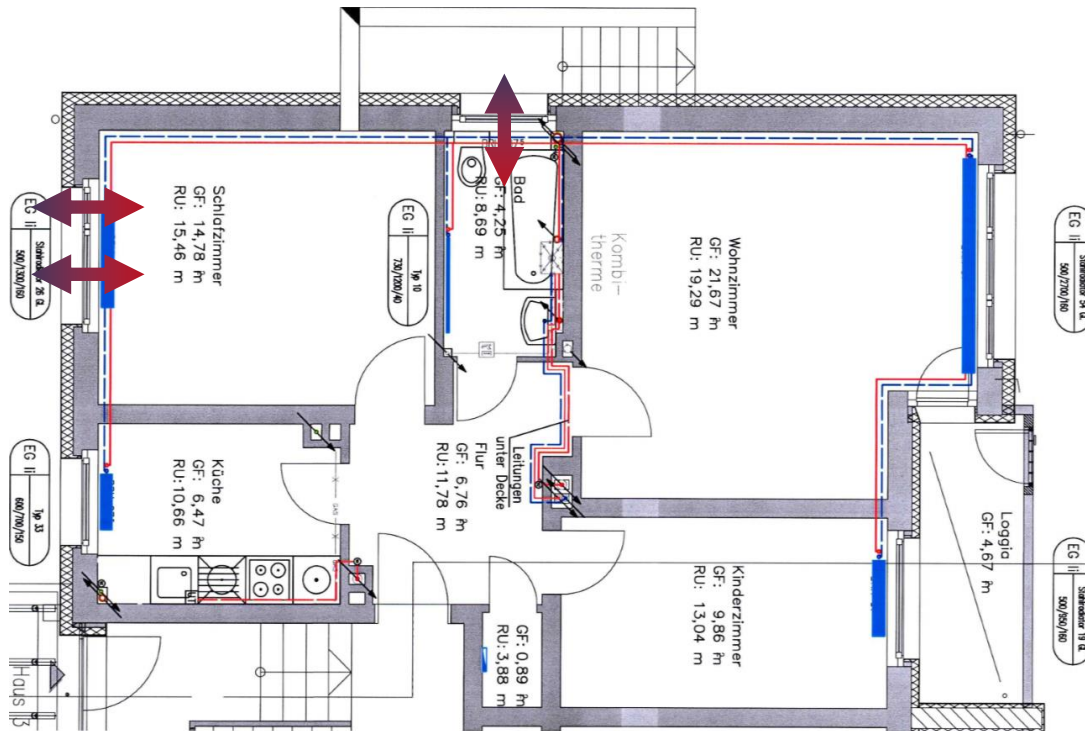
Grundrissausschnitt EG eines Mehrfamilienhauses, Abbildung Firma Grundlach-Wohnungsunternehmen.
